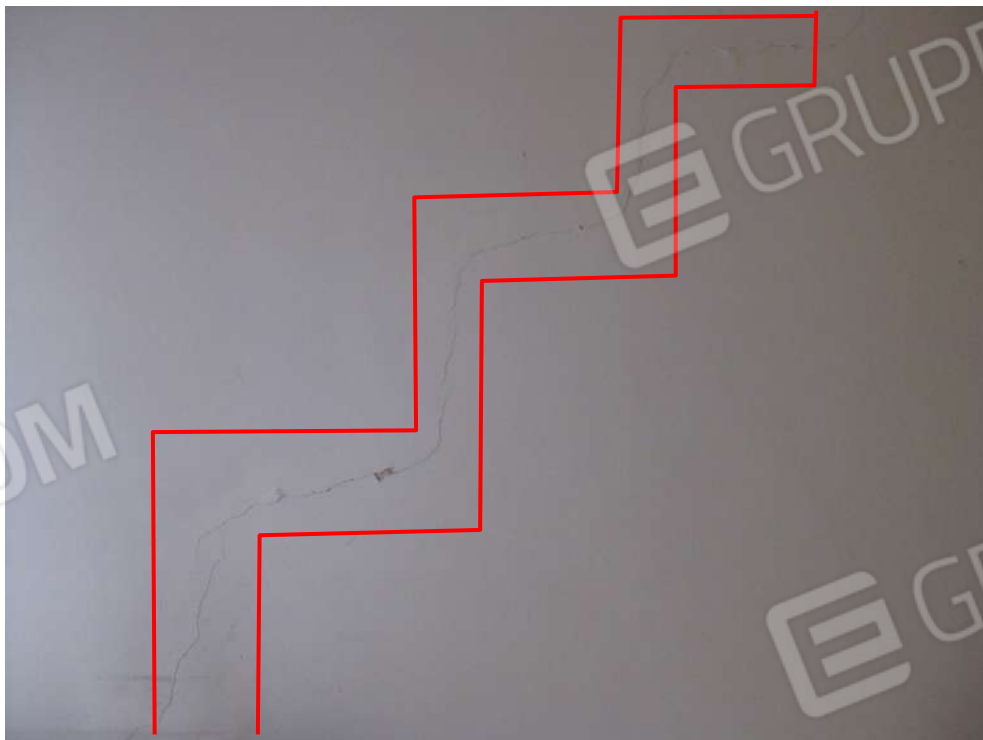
Particolare della fessura presente sul muro in corrispondenza del radiatore della stanza
